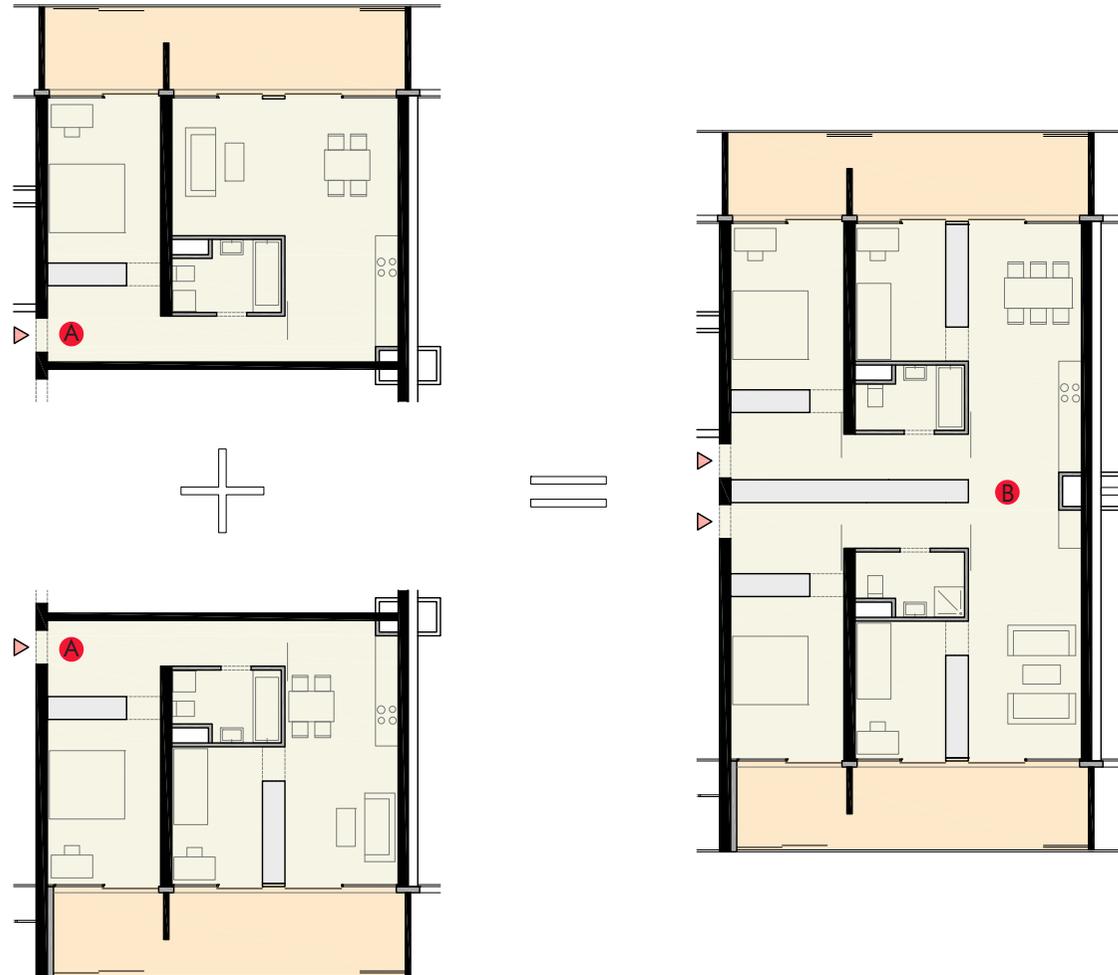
Grundrissflexibilität: durch Zusammenlegen am Beispiel Bestand 1: Typ A + Typ A = Typ B
